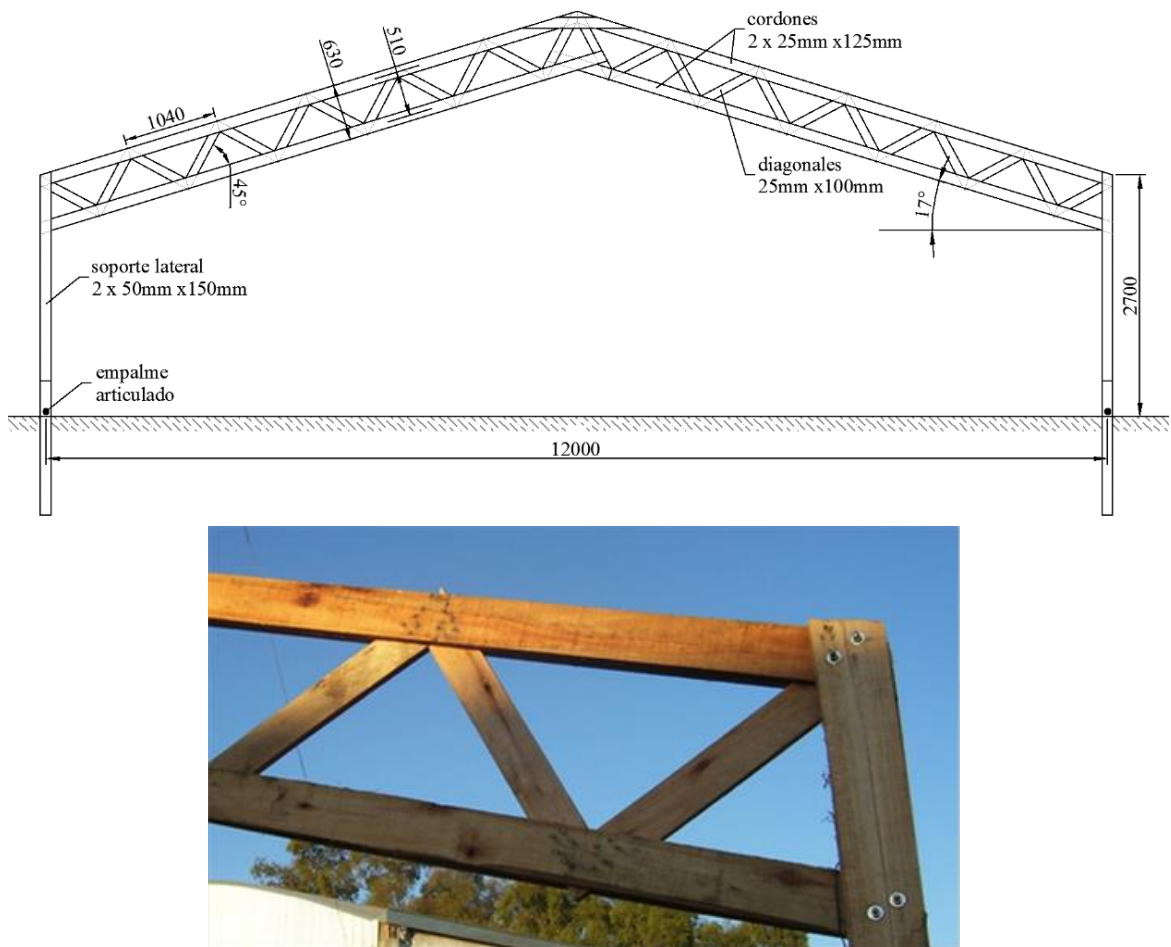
Características de la estructura reticulada. Configuración general (arriba), detalles constructivos (abajo).
